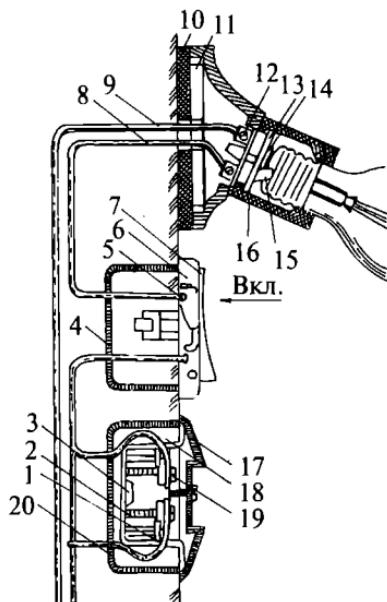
Установочная аппаратура: 1 — распорная лапка; 2 — корпус розетки; 3 — скоба-фиксатор; 4 — монтажная коробка; 5 — контакт выключателя; 6 — остов выключателя; 7 — клавиша выключателя; 8 — проводник (фаза); 9 — проводник («земля»); 10 — подрозетник; 11 — основание патрона; 12 — контакт патрона; 13 — вкладыш; 14 — центральный пластинчатый контакт патрона; 15 — боковой пластинчатый контакт патрона; 16 — юбка патрона; 17 — крышка розетки; 18 — гнездо розетки; 19 — контакт розетки; 20 — монтажная коробка
